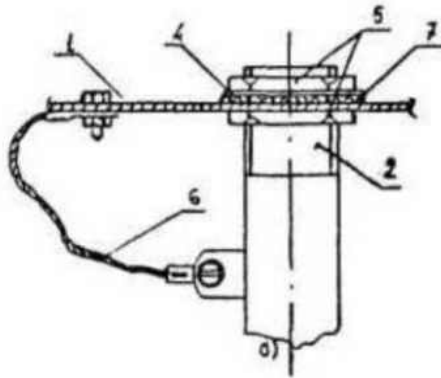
Ввод в оболочки и аппараты труб с резьбой с уплотнением 1 - корпус аппарата (коробка, ящик), 2 - труба, 4 - шайба, 5 - контргайка, 6 - переключка ППС, 7 - прокладка резиновая.
